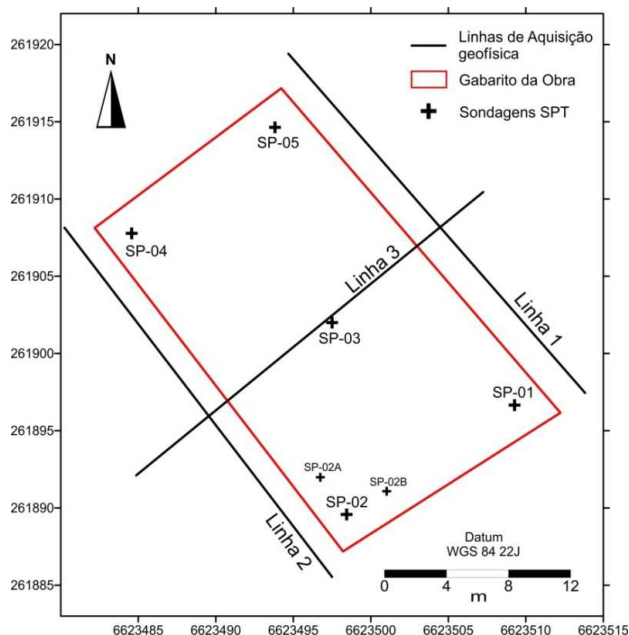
Planta de localização dos furos de sondagem e dos perfis geofísicos executados
